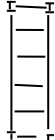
Размещение балок настила при установке главных балок на колонны сверху
